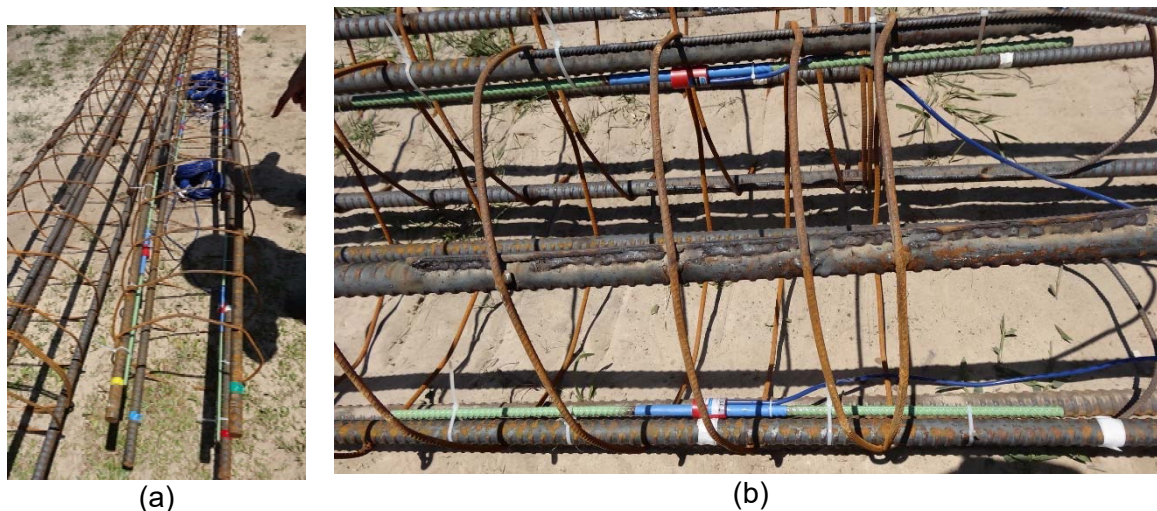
Strain gages* fixados à armadura longitudinal: (a) vista geral e (b) detalhe
